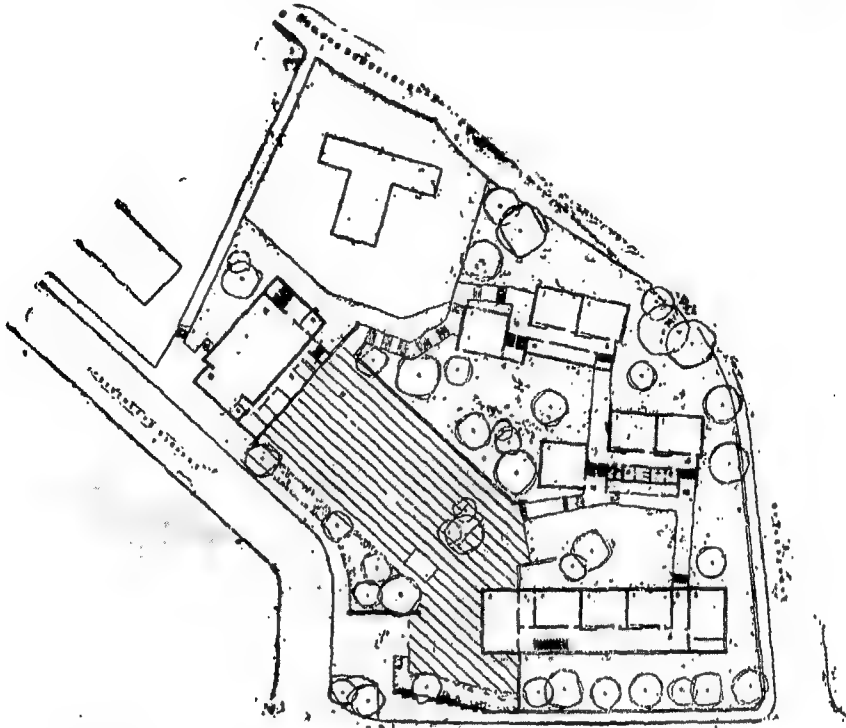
٢٧ - ٦ : مسقط افقى للدور الأرضى .
